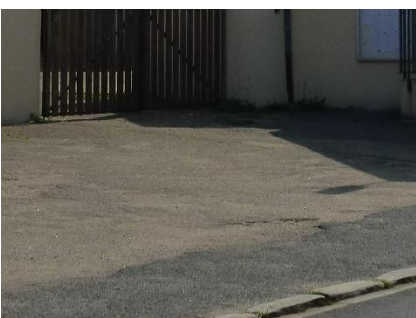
Trottoir en bitume, (photo Urbanea, 2021)
